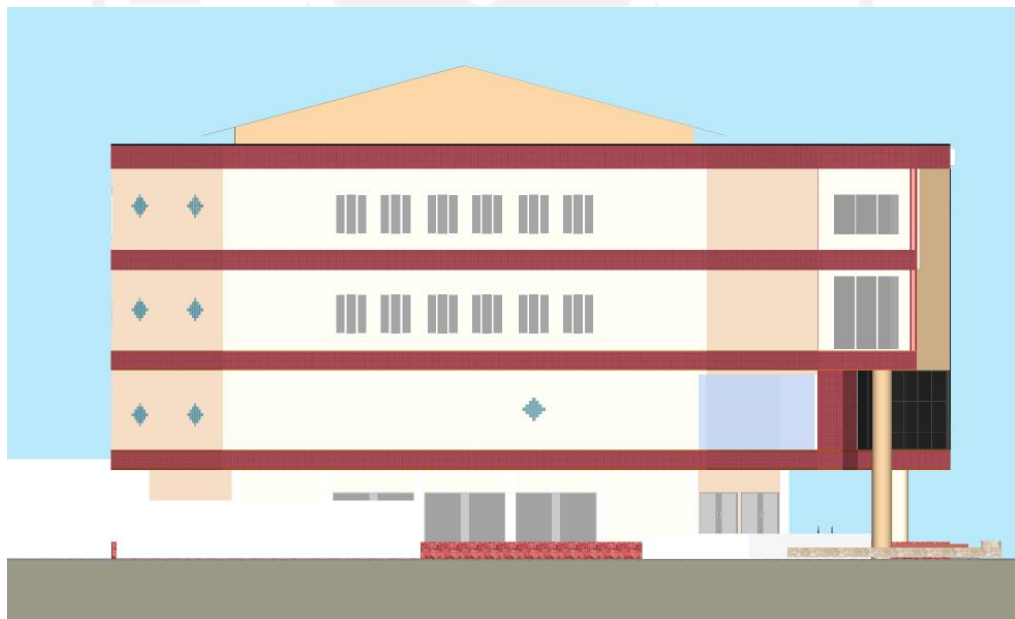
11 Fasad Tampak Timur Eksisting
